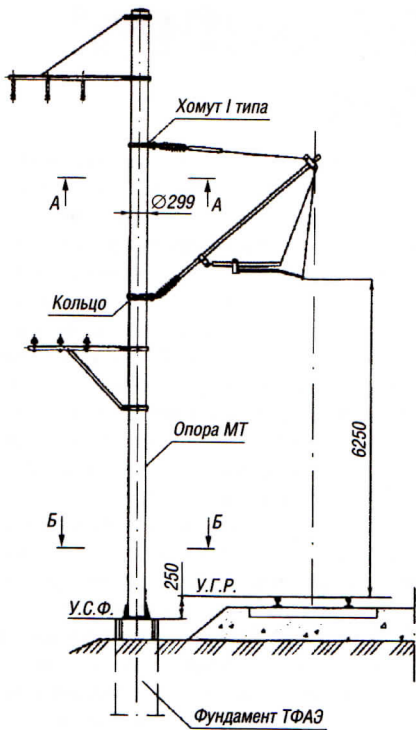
Схема крепления ригеля на трубчатой опоре МТП
